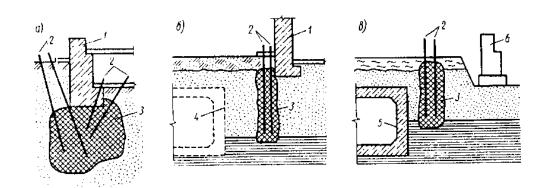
Схема закрепления методом силикатизации оснований фундаментов (a), защиты фундаментов зданий при строительстве подземных сооружений (б), при возведении зданий (в):
